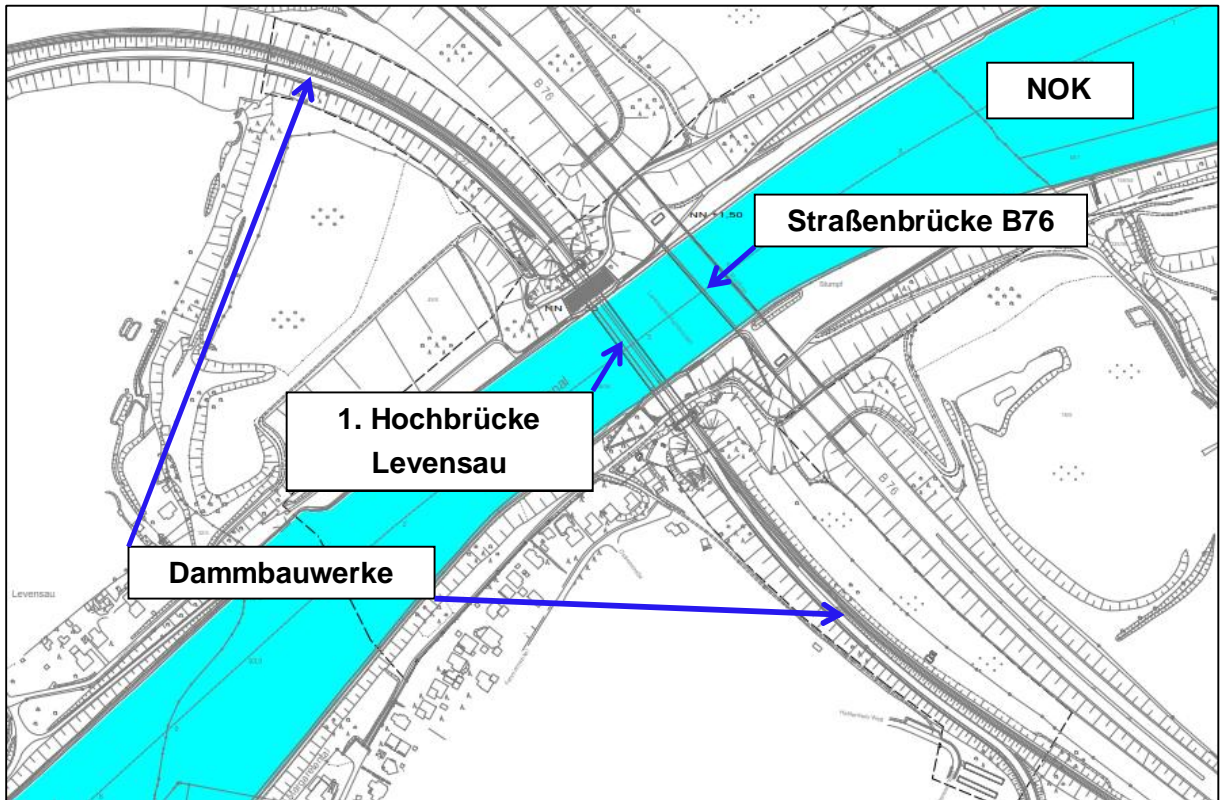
Übersichtslageplan Brücken und Dammbauwerke (Plangrundlage aus /U2/)
